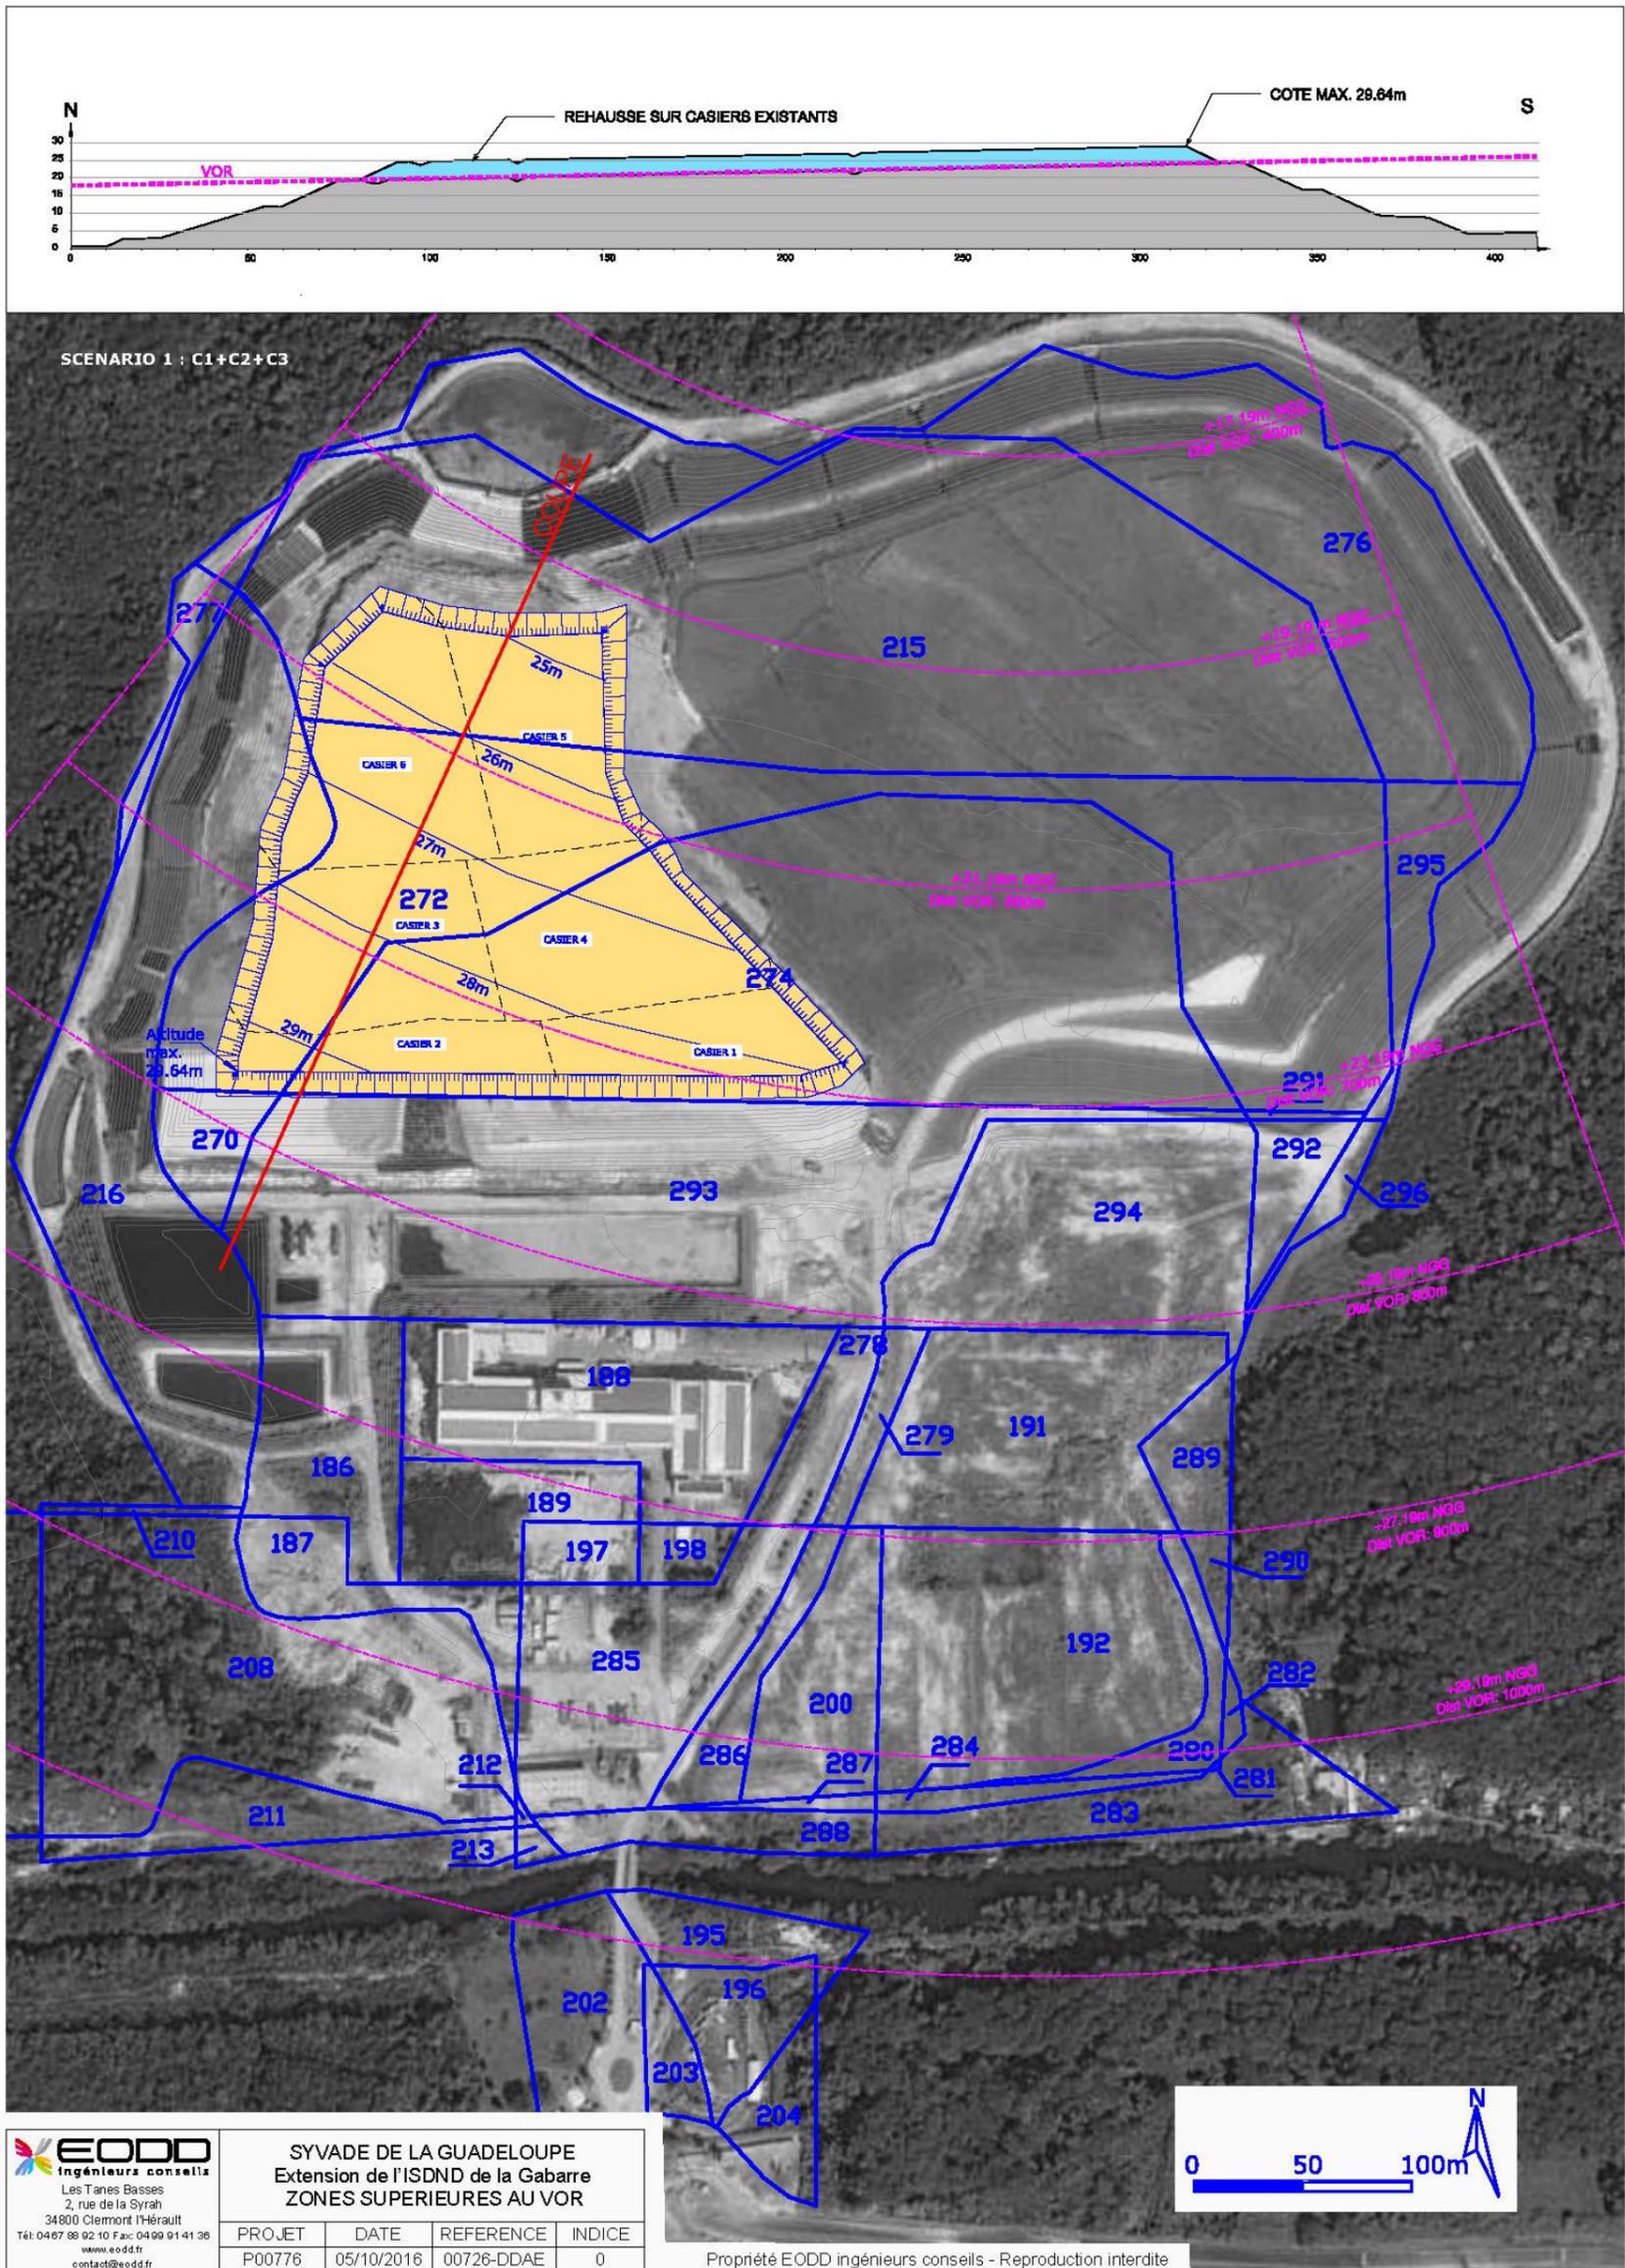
Plan masse et profil de la zone de rehausse projetée
